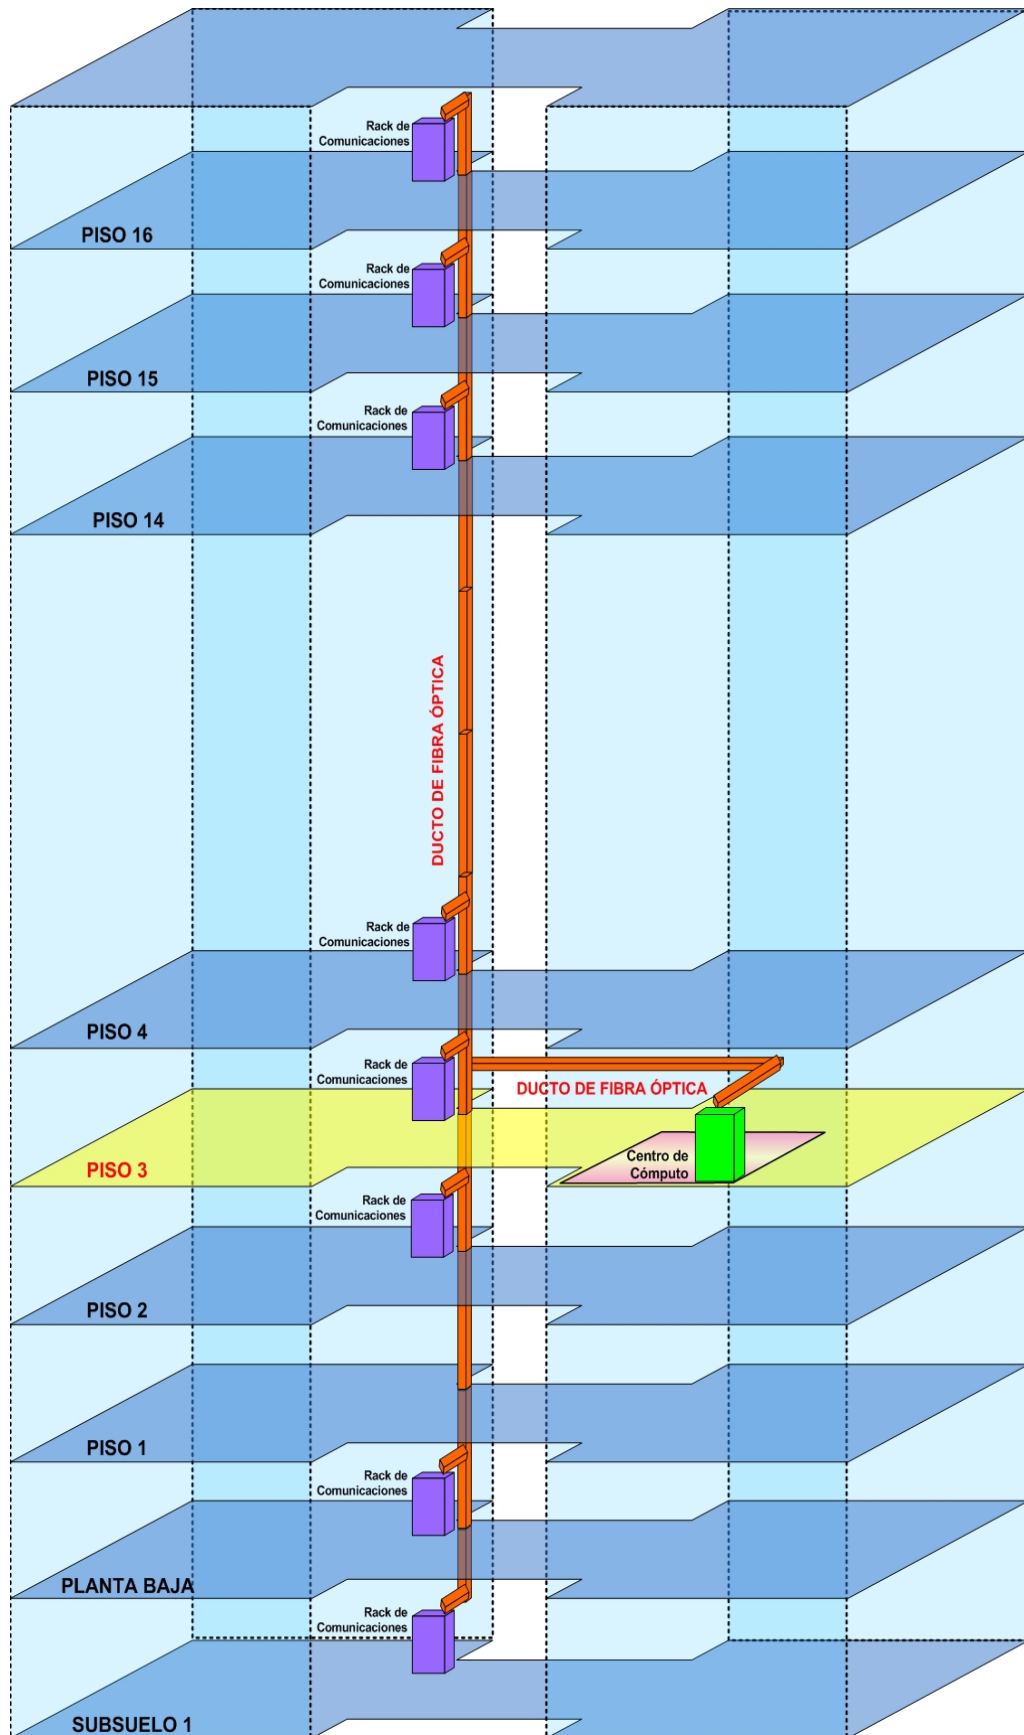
Ducto vertical para el cableado estructurado de fibra óptica
